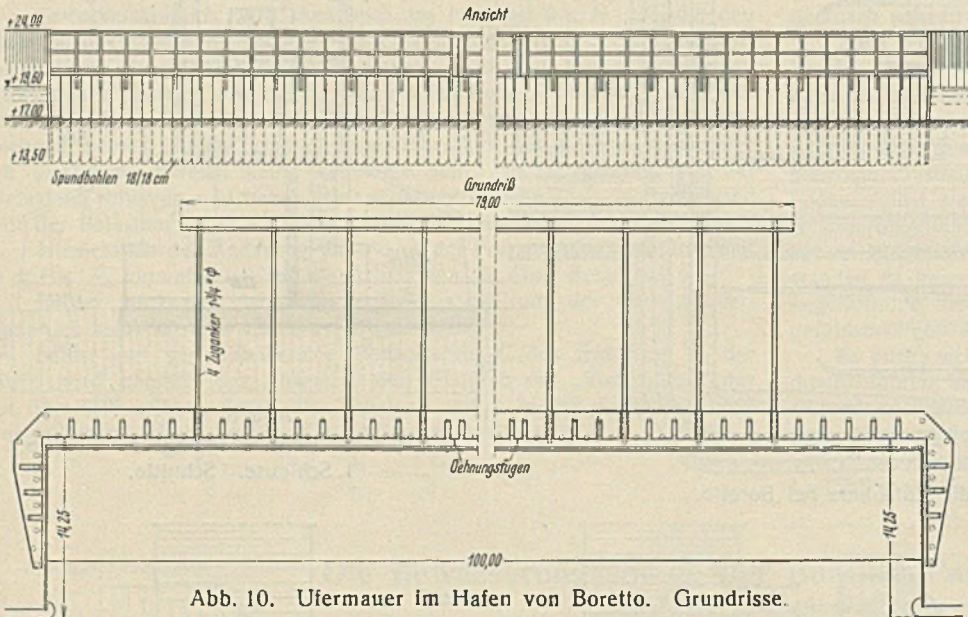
Ufermauer im Hafen von Boretto. Grundrisse.
